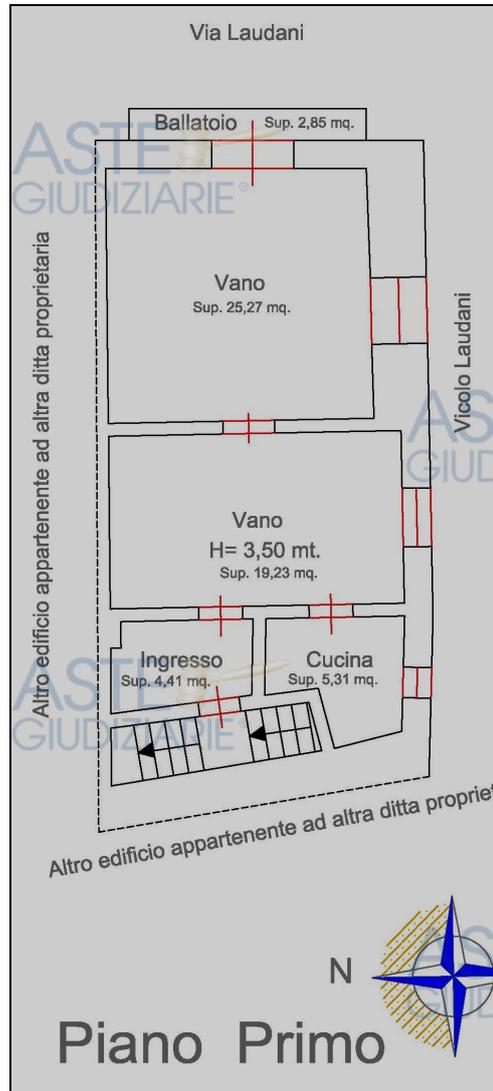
Visualizzazione della planimetria dell'immobile a piano primo con indicazione delle superfici utili
